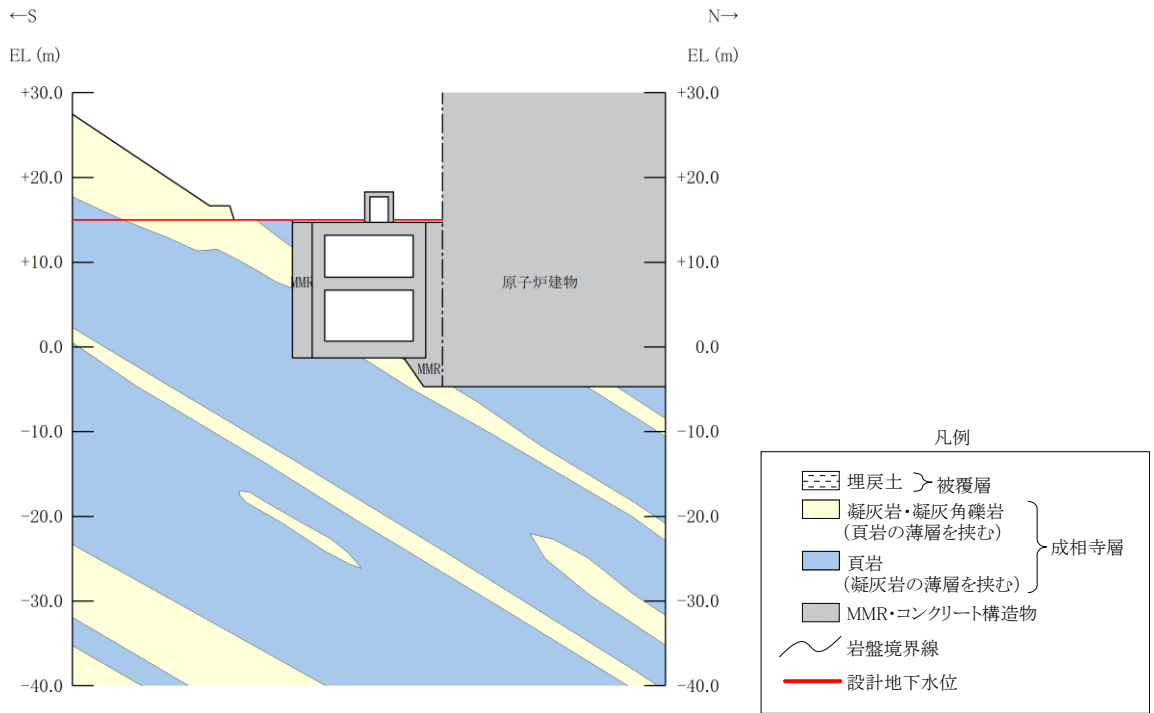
低圧原子炉代替注水ポンプ格納槽 評価対象断面図 (A-A 断面)
